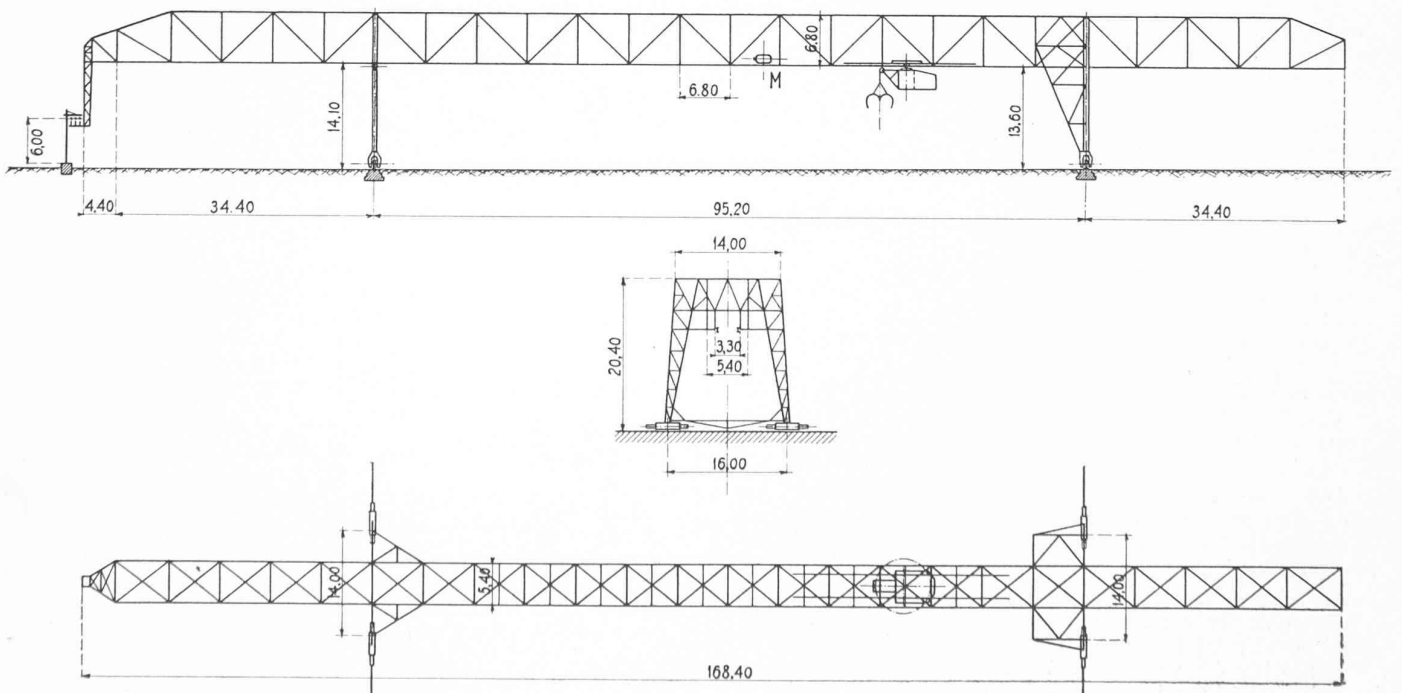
Elévation, plan et coupe du pont roulant d'Attisholz. — Echelle 1: 1000.
